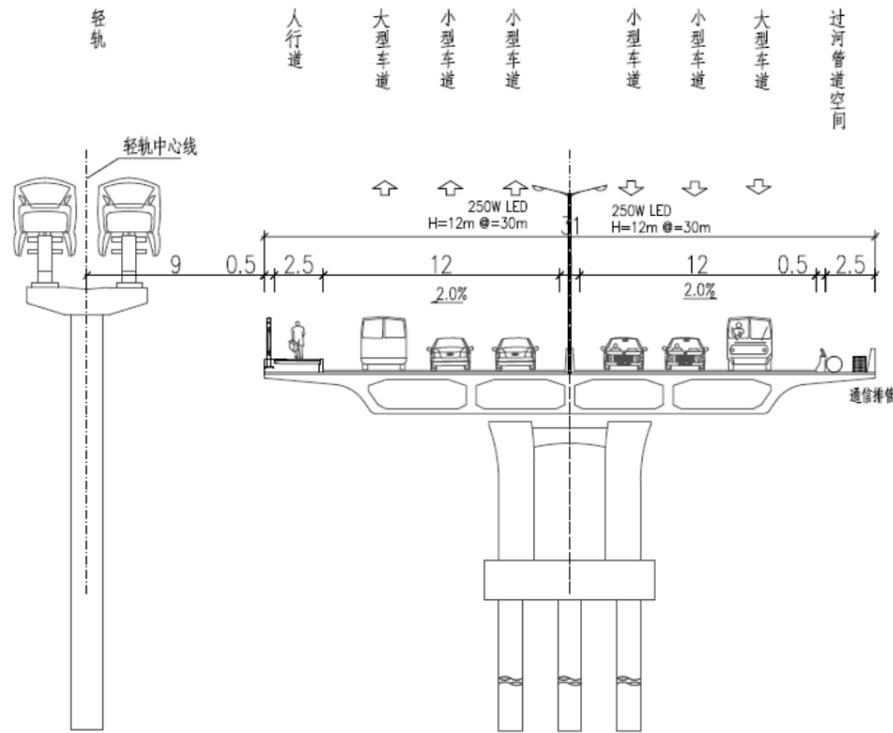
金沙西路西延（K4+000-K4+680）照明横断面图（尺寸单位：m）
